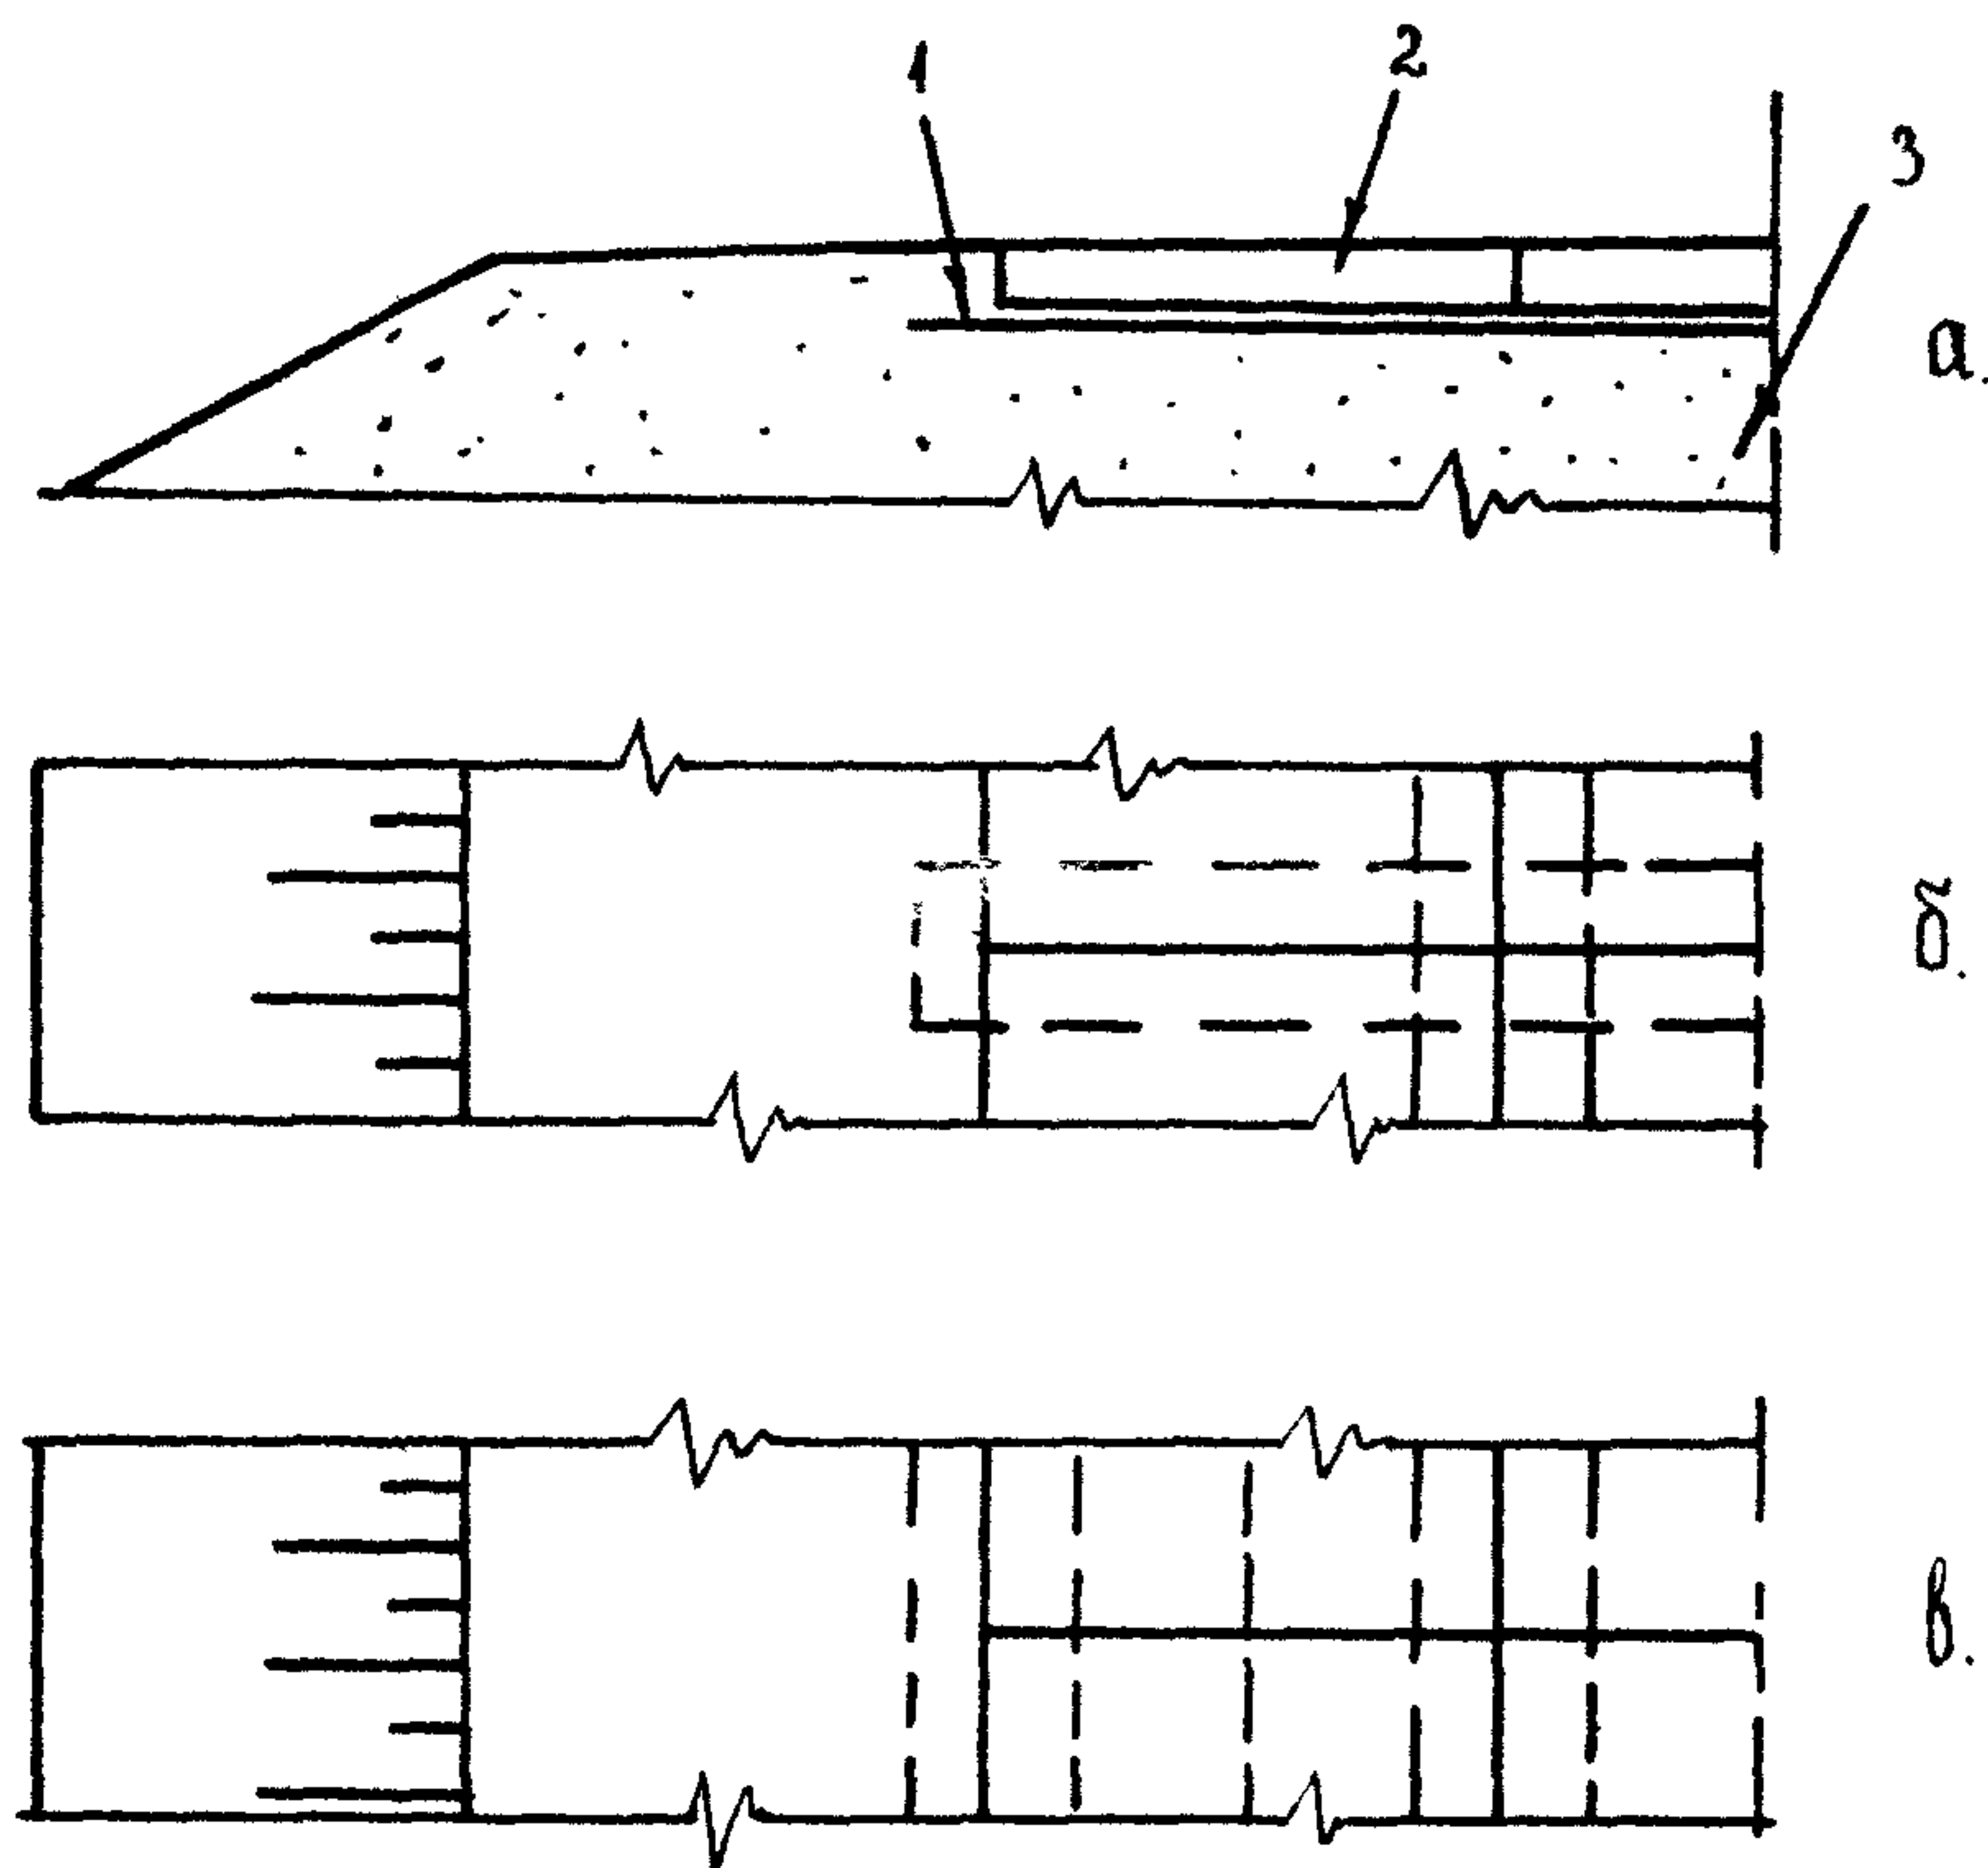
Сборное покрытие на неукрепленных основаниях с прослойками геотекстиля:
